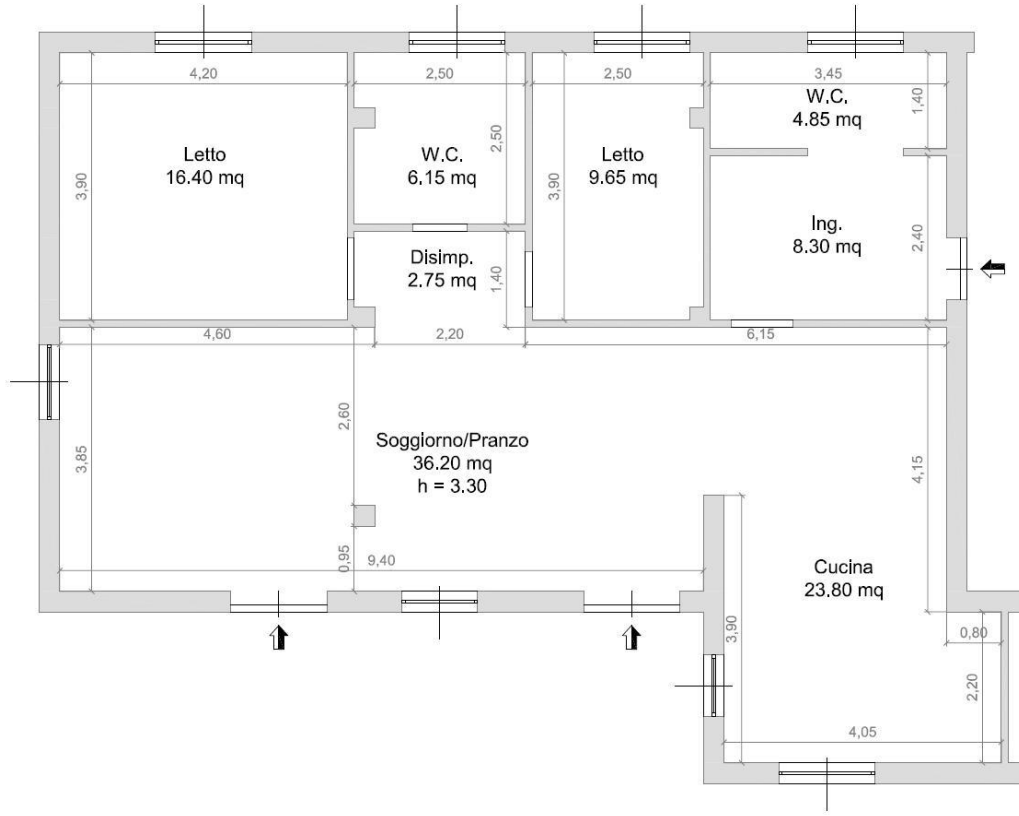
Planimetria Catastale Foglio 46, p.lla 1235, sub 3.
